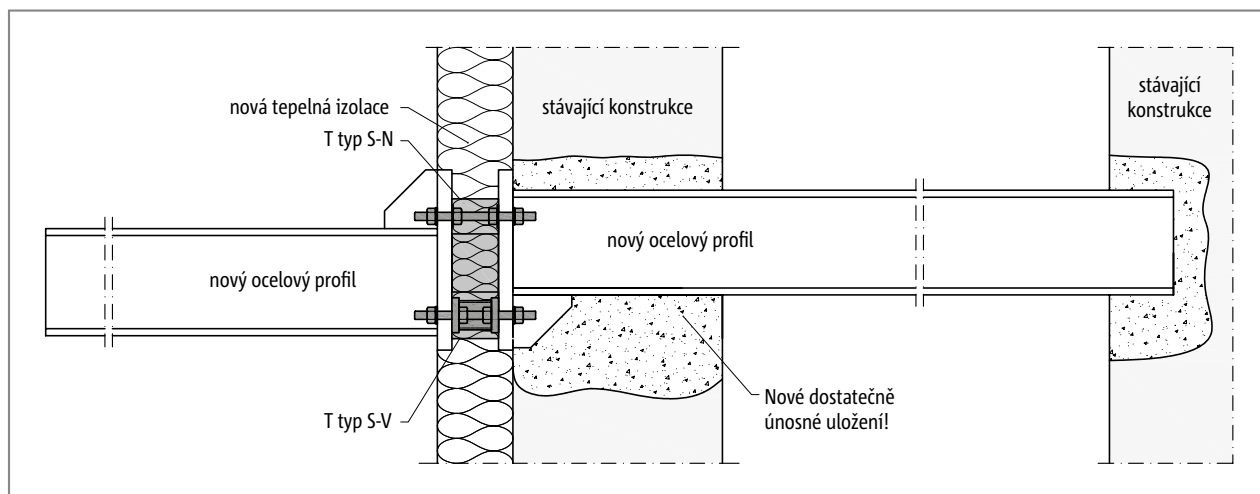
Schöck Isokorb® T typ S-N a T typ S-V: Dodatečně provedený volně vyložený ocelový balkón; napojení na dodatečně zabudovaný ocelový nosník
